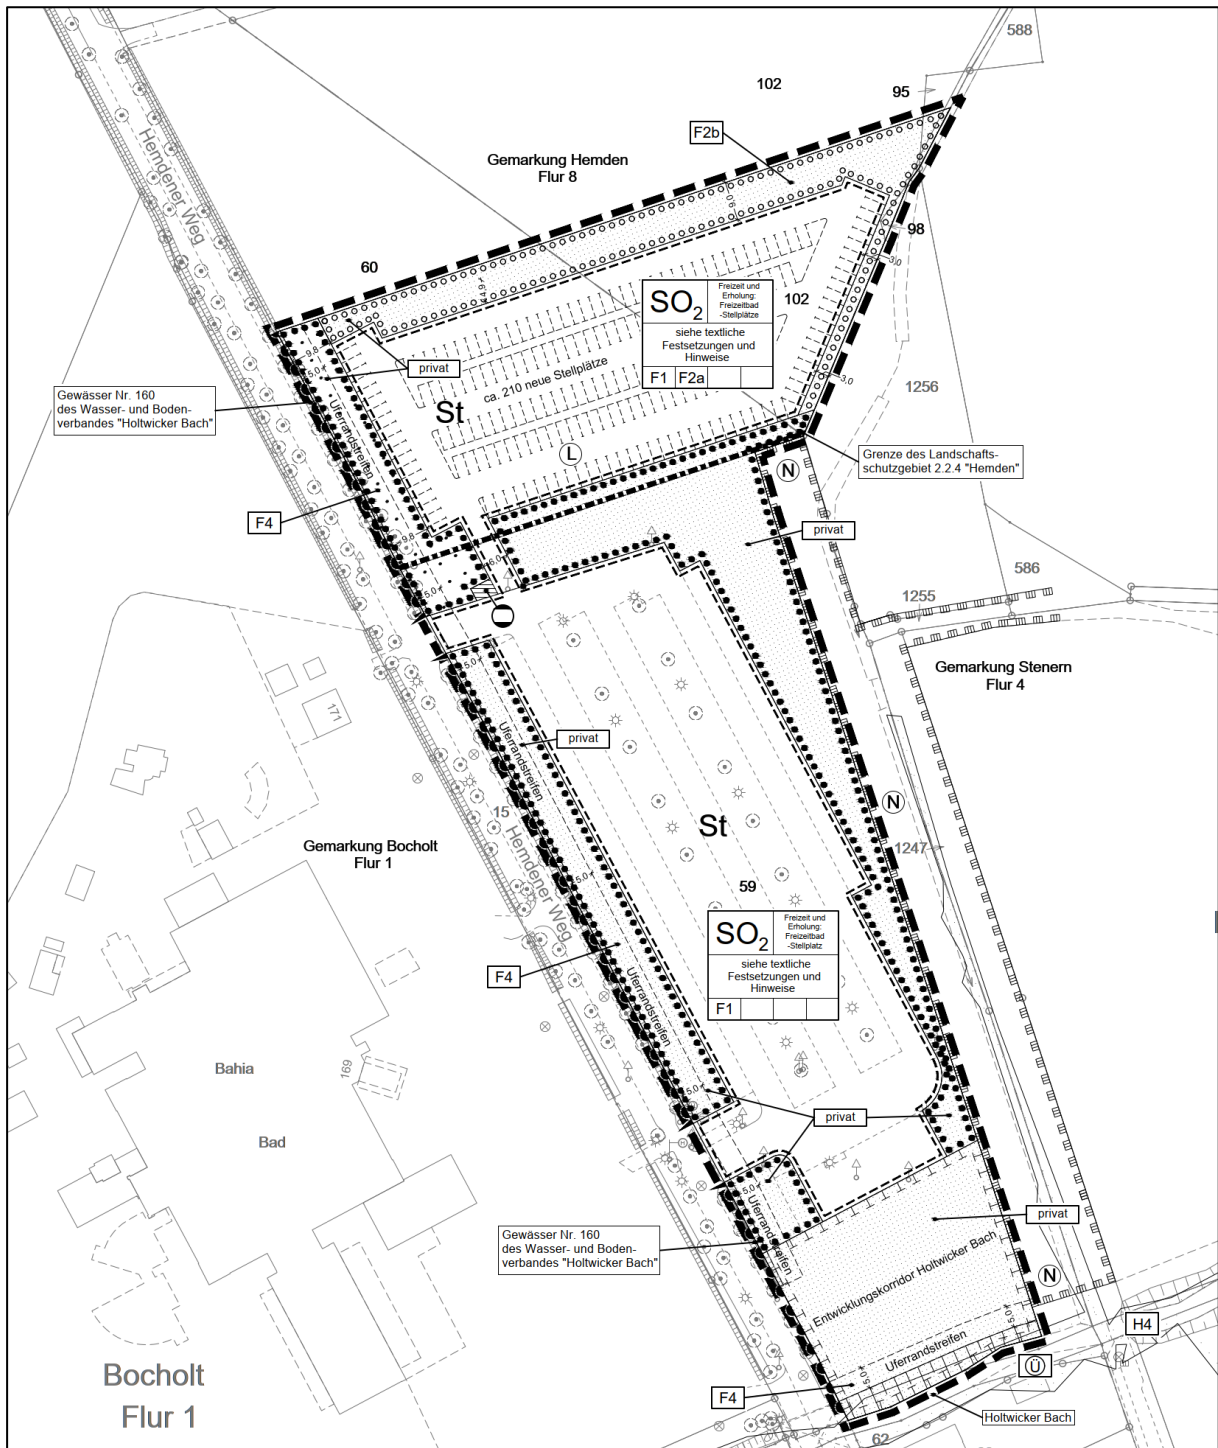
Bebauungsplan NW 26 – Erweiterung Stellplatz BAHIA
